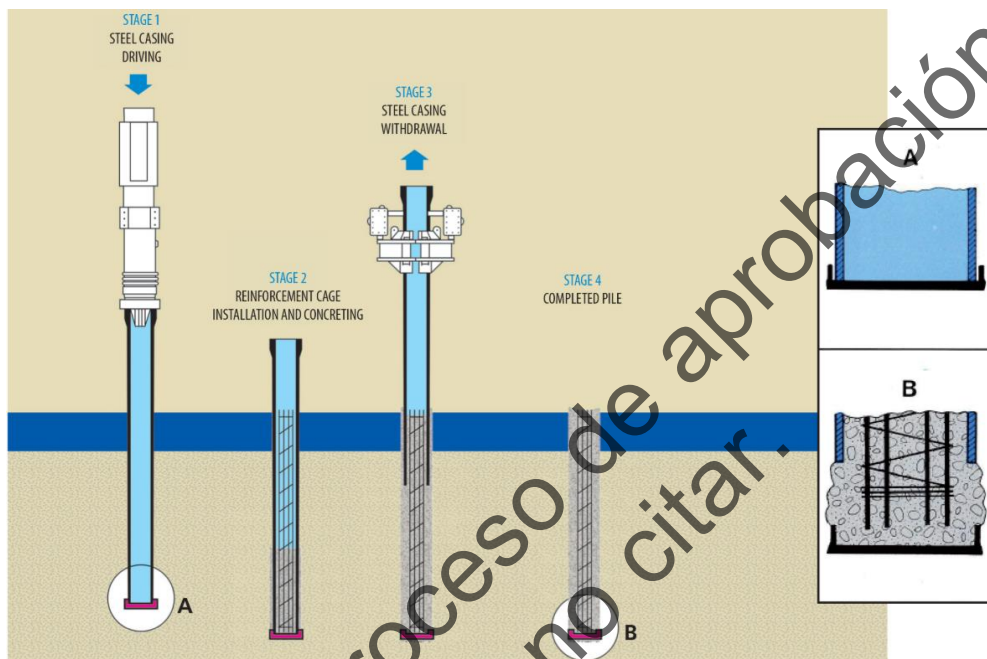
Esquema de pilote de desplazamiento sin excavación.
